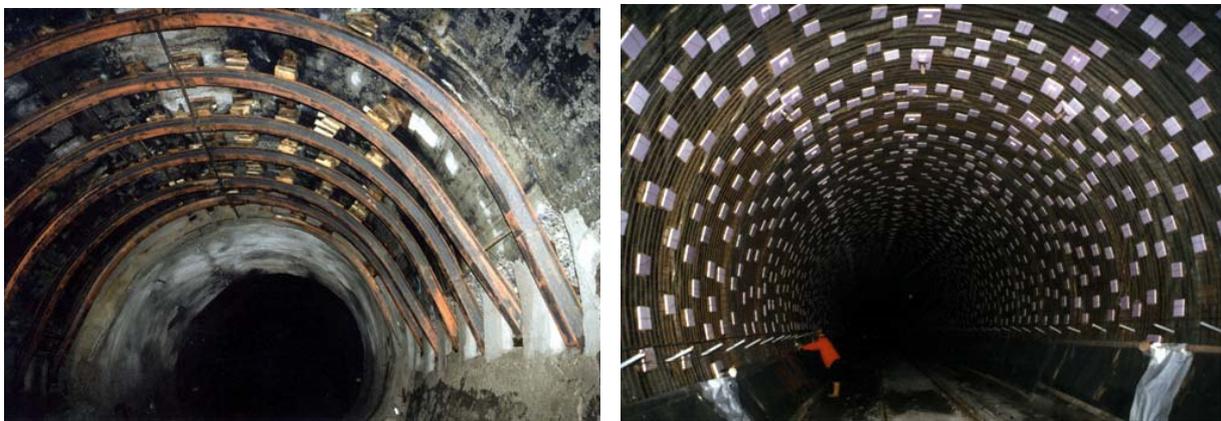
Josefsbergtunnel vor und nach der Sanierung. Quelle: GMK Bauingenieurbüro.
